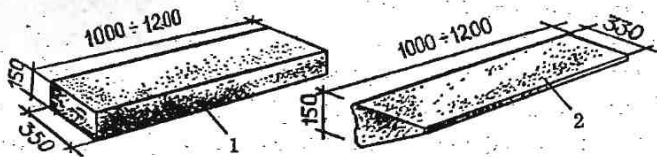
Готовые бетонные блоки: 1 — прямоугольный бетонный блок; 2 — готовый блок под косоур
